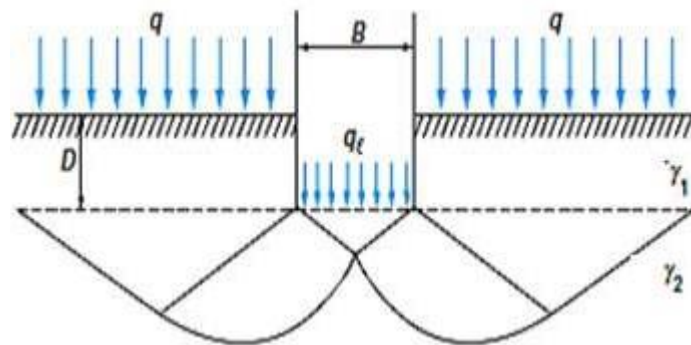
Surface de rupture par cisaillement général supposée par Terzaghi (1943) pour une semelle filante
